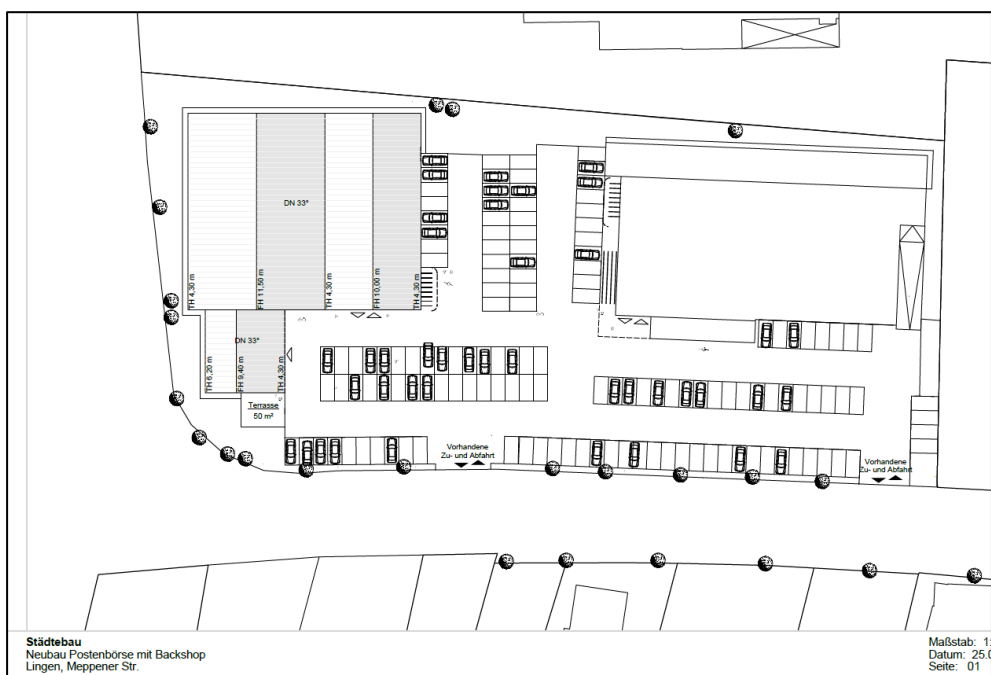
Lageplan geplante Parkplatzgestaltung
